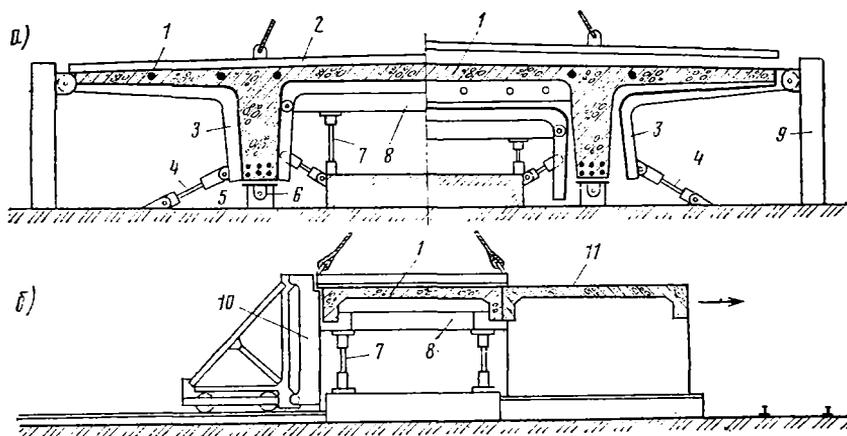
Схема технологической оснастки для изготовления блоков плитно-ребристой конструкции (ПРК):
